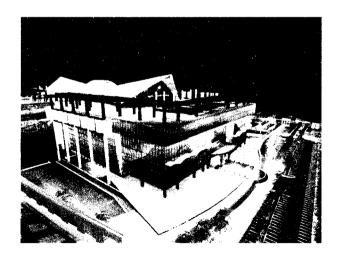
Gambar Shading electric dan cylinder Baja
